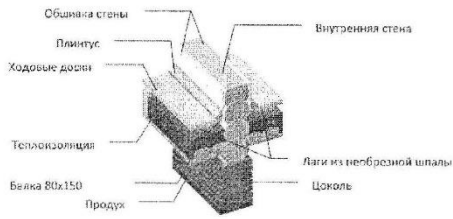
Конструкция перекрытия в домах с бревенчатыми стенами
